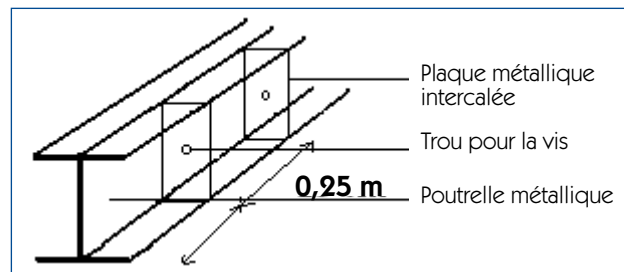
Poutrelle métallique avec plaques métalliques soudées (vue en 3 dimensions)
